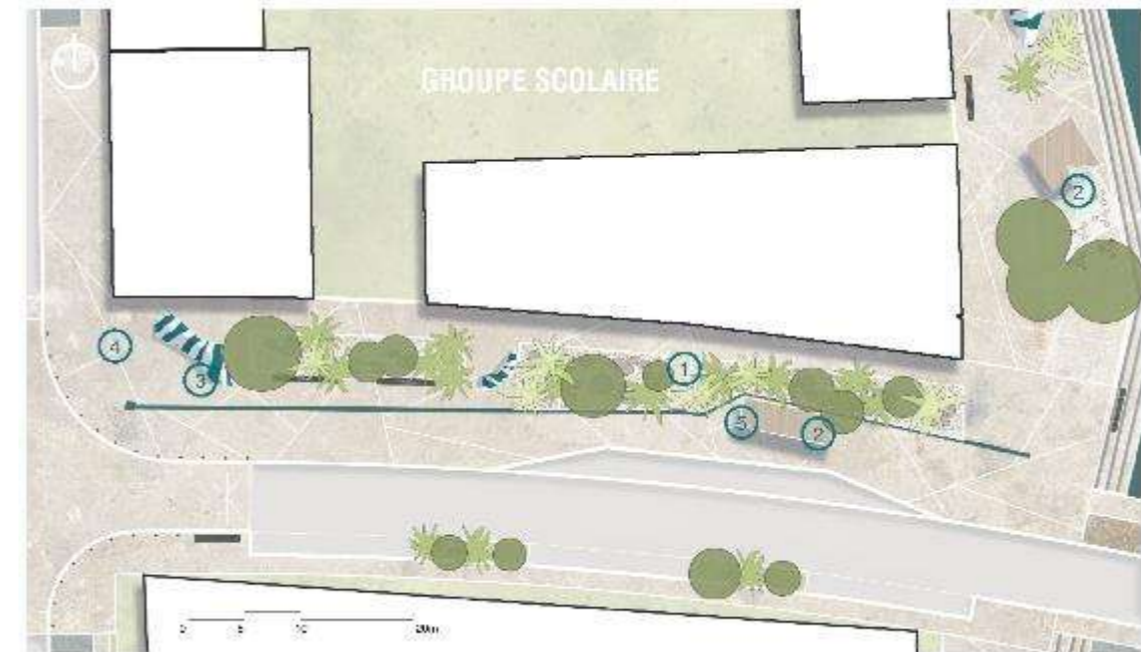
PLAN MASSE DU PARVIS DU GROUPE SCOLAIRE (A234, AVP 2020)
